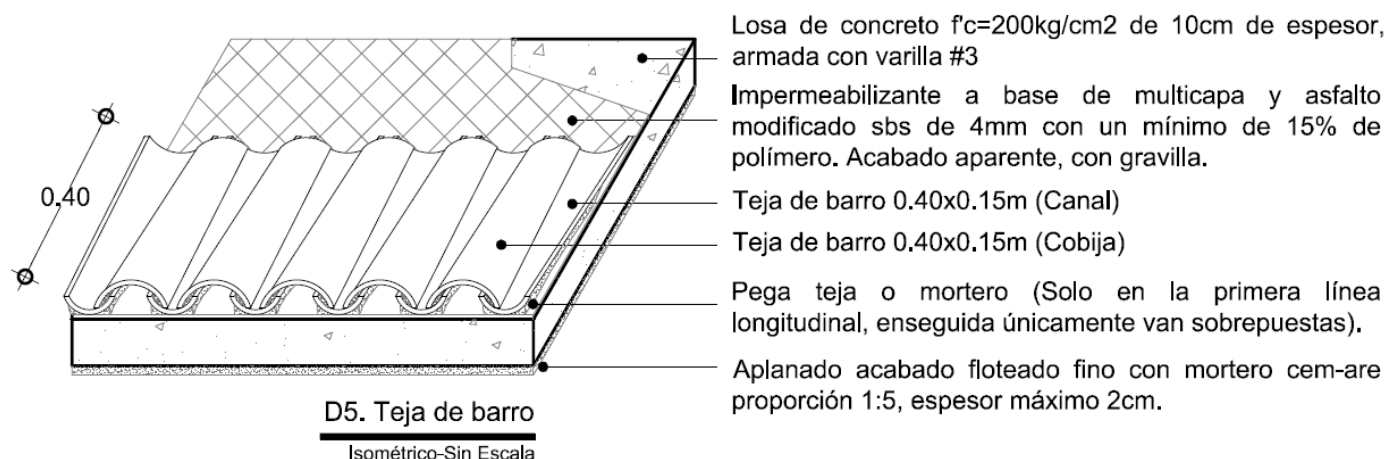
Detalle 5. Techo escudo-Teja de barro (Isométrico).
